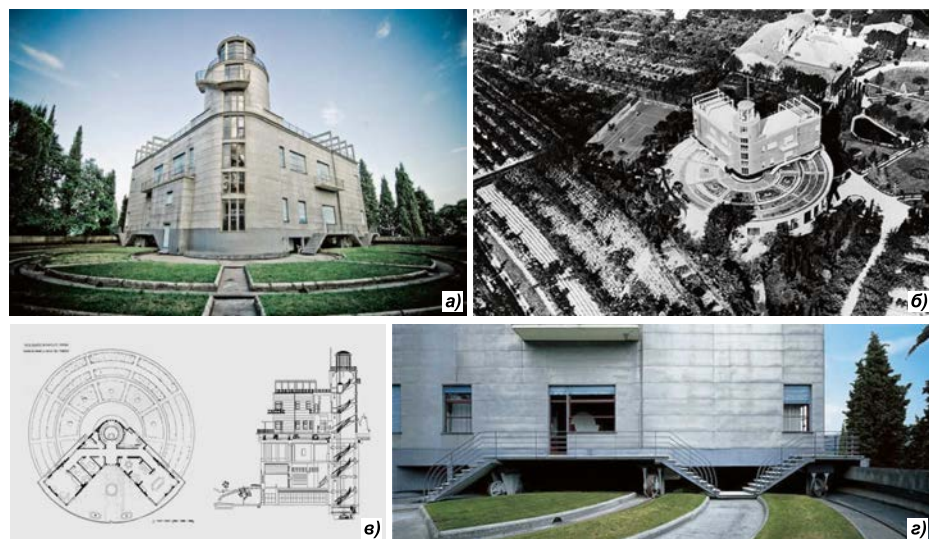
Вилла «Джирасоле»: а — фасад; б — общий вид; в — план и разрез; г — фрагмент фасада. URL: <http://mixstuff.ru/archives/43807>
